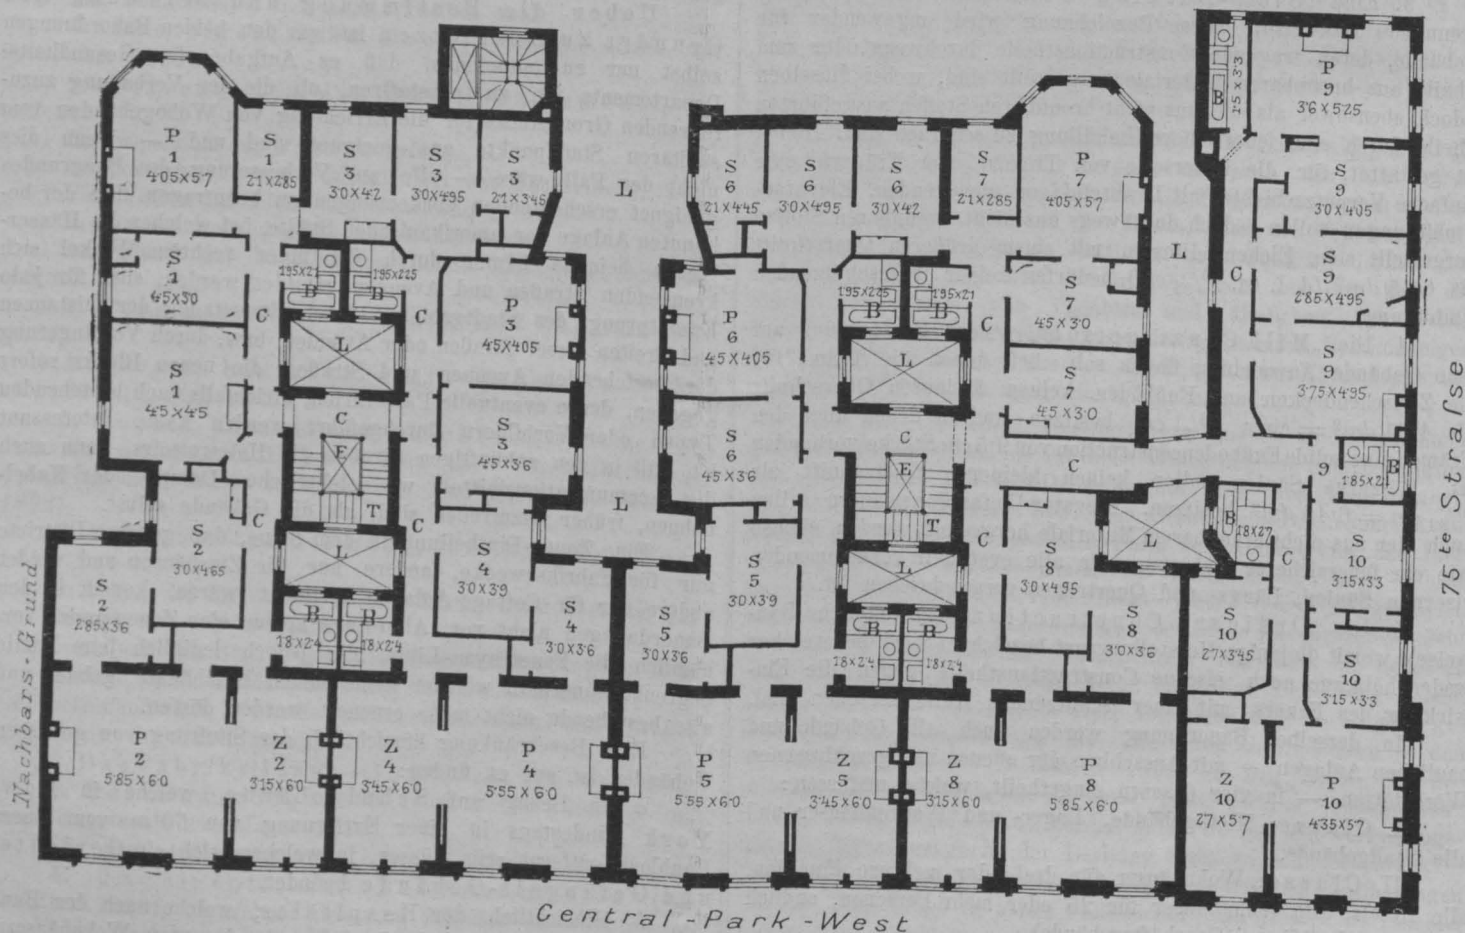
Grundriss des Hôtel „San Remo“, New-York. 1:266.
